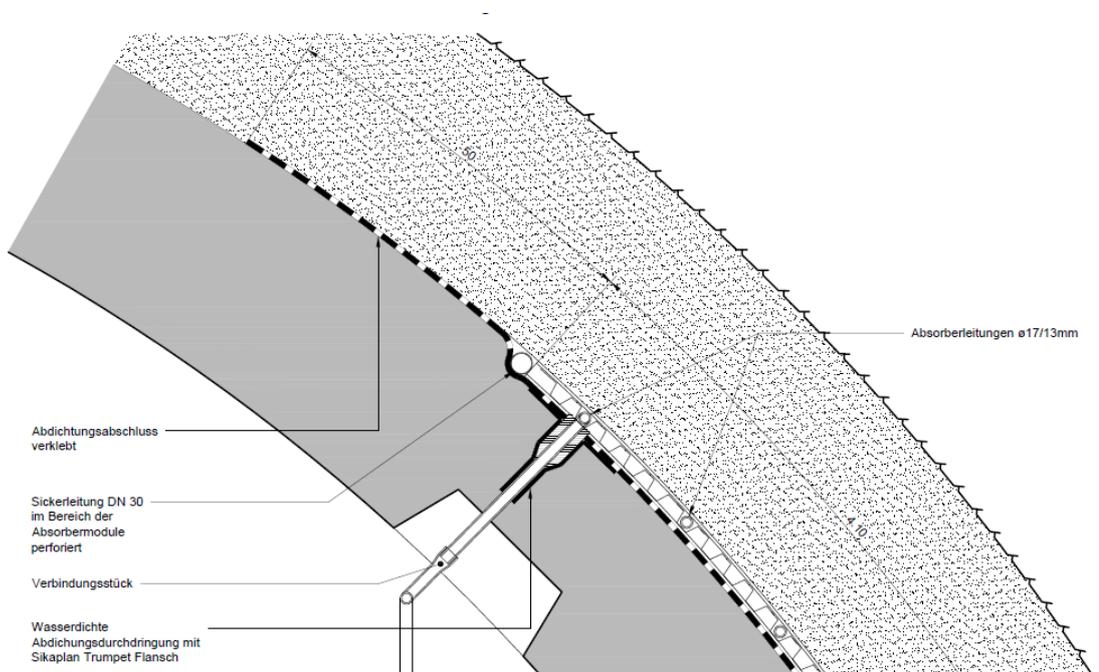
Detail Abdichtungsdurchdringung [Auszug aus Plan Anhang A1]
